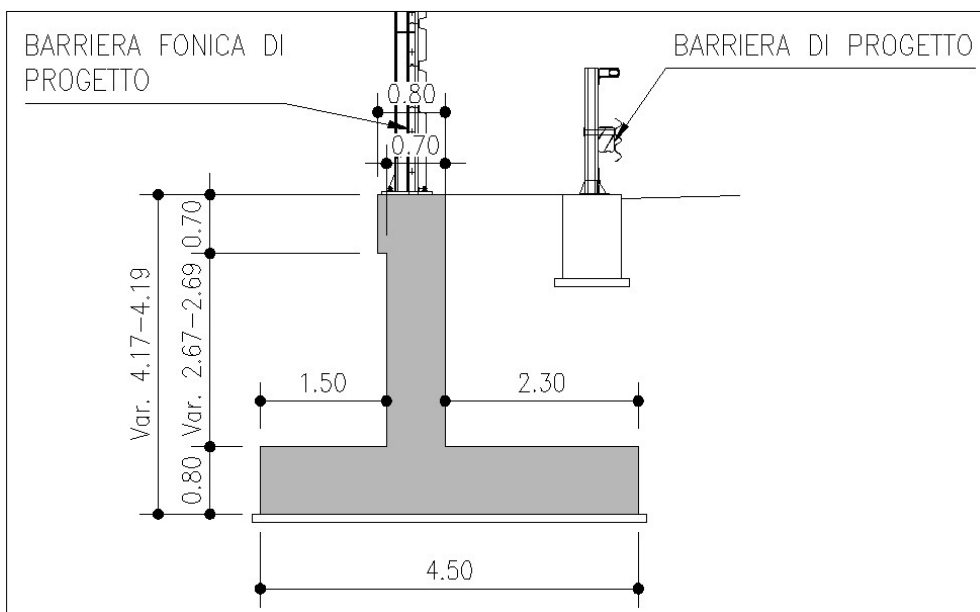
Sezione trasversale del muro andatore lato Rimini – Allargamento Sud
